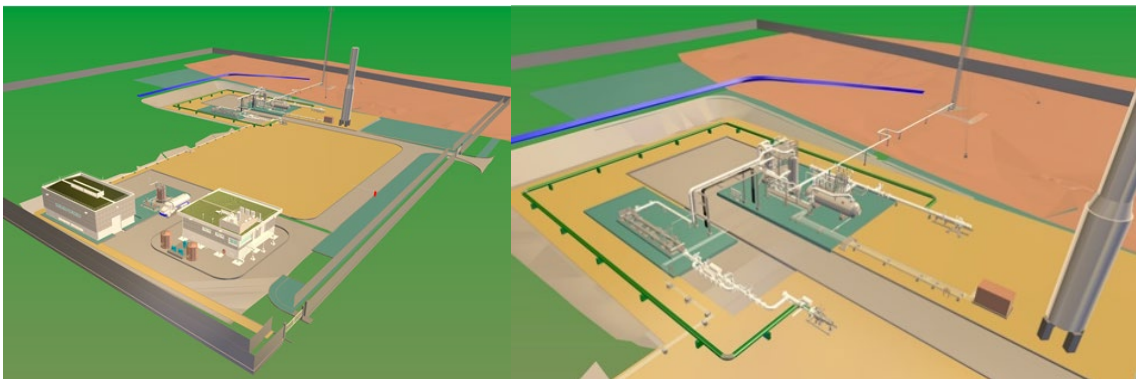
Imagens proveniente do ficheiro 3D das Instalações.
